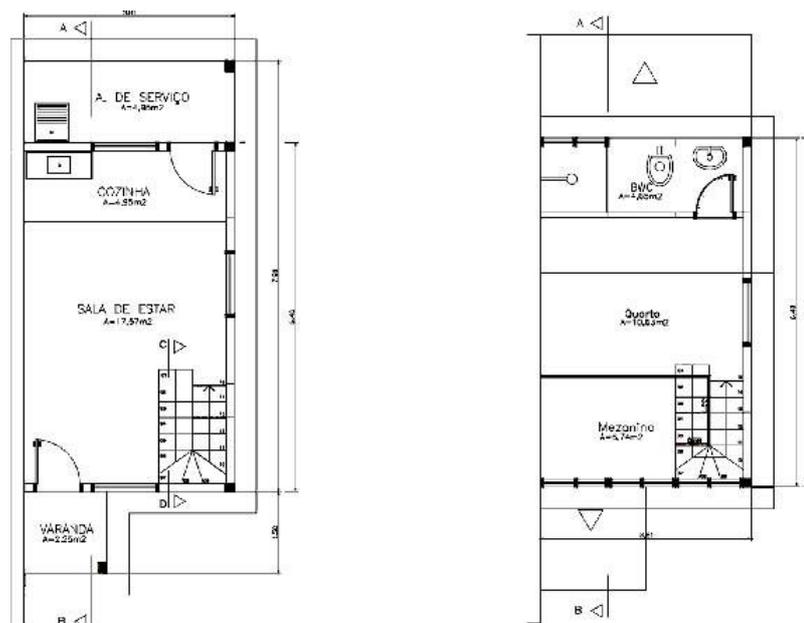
planta térreo e pavimento superior da Casa Stella-UFSC
